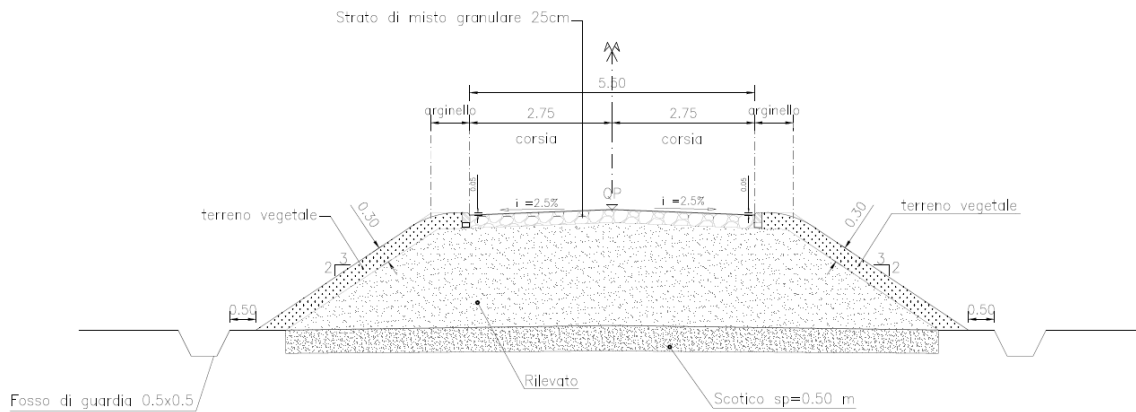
VIABILITÀ NV05 - SEZIONE TIPO IN RILEVATO
